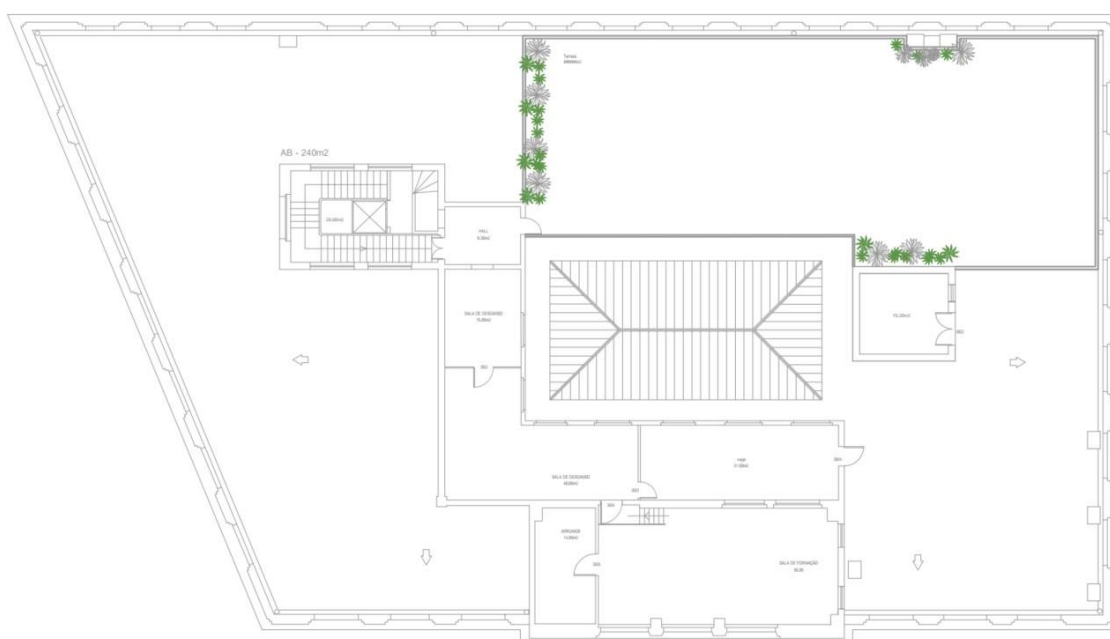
Edifício TUMO: planta da Cobertura.
